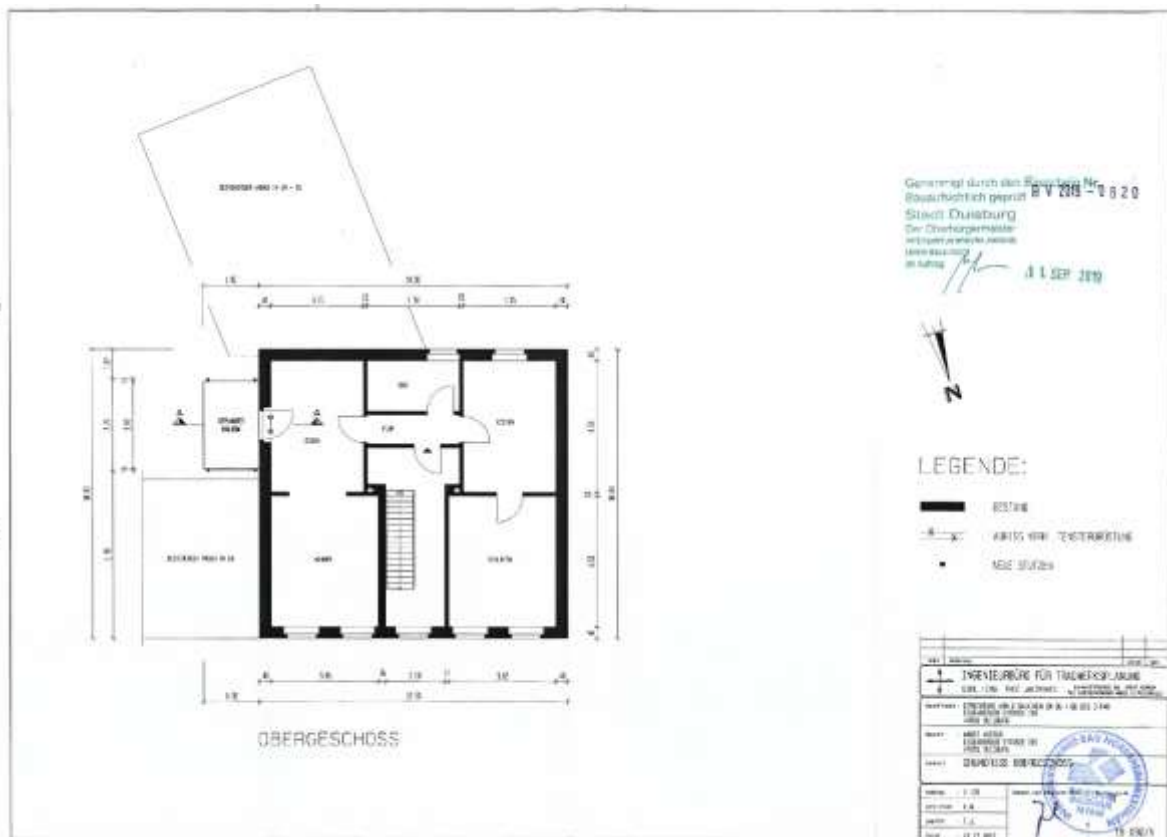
Grundriss Obergeschoss (Bauantrag Balkone) Quelle: digitale Bauakte Stadt Duisburg
